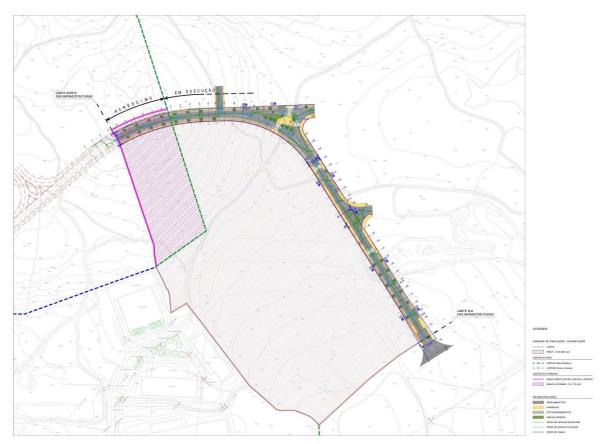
Unidade de Execução 01/UOPG 20 – Infraestruturas | Planta parcelar de infraestruturas
